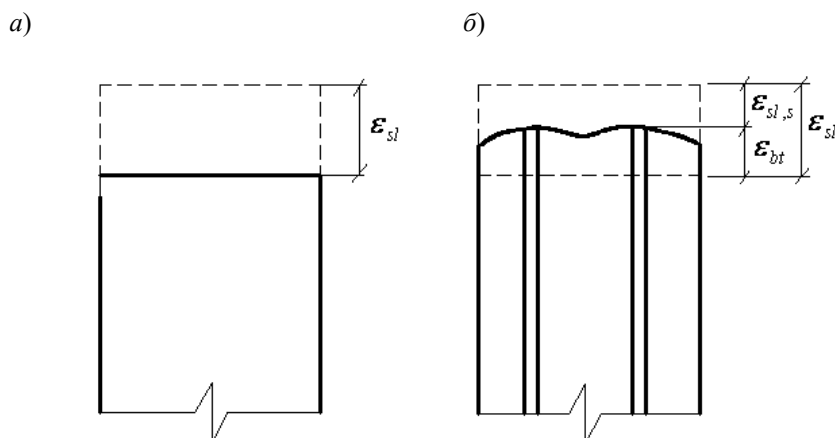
Деформации усадки образцов: а – бетонного; б – железобетонного
